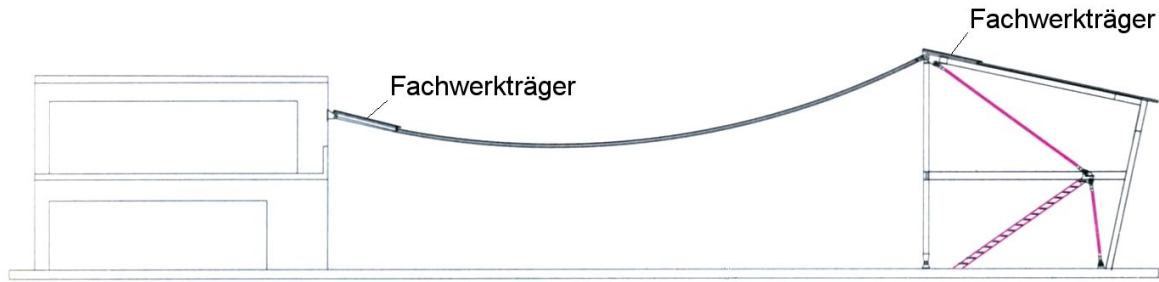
Querschnitt durch das Hängedach mit anschließenden Gebäuden, Werkhof der Stadtwerke Hohenems, Architekt: Drexel, Ingenieur: Merz (BNr. 60) [Merz 2001]
